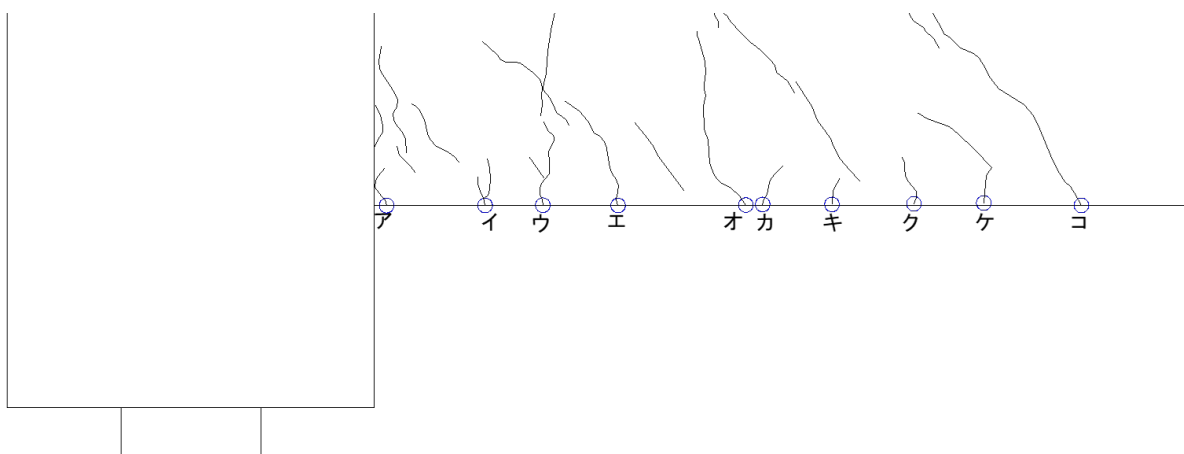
基礎梁ひび割れ幅測定位置 (試験体 A-3 正載荷)
